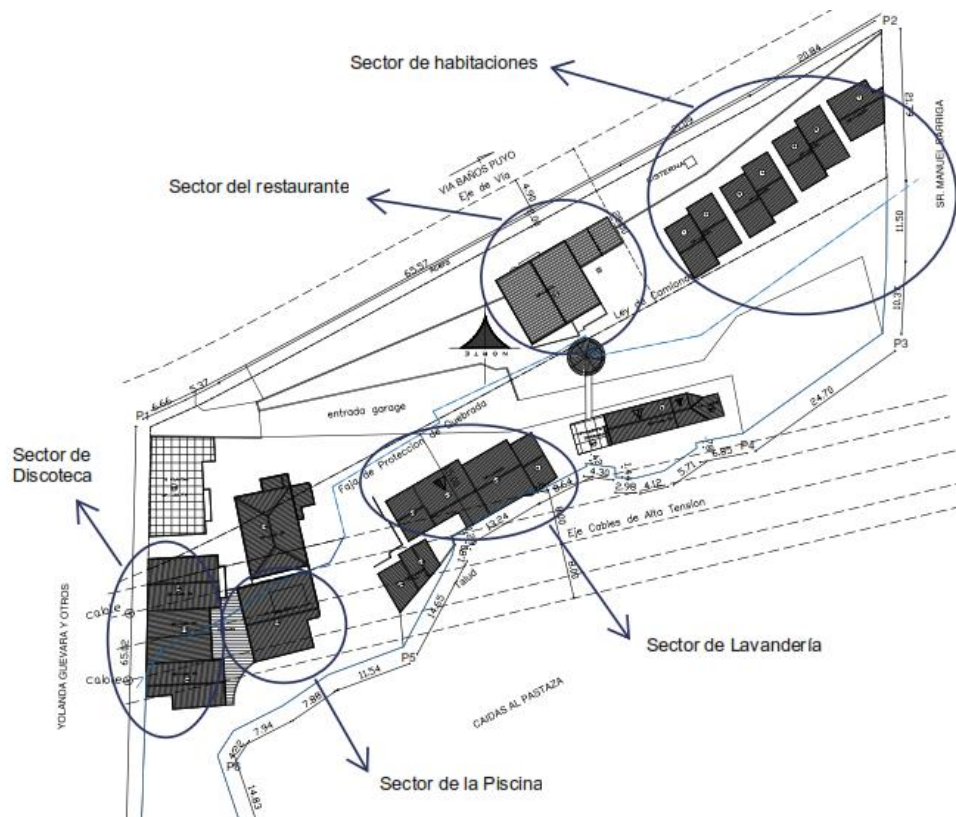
Planimetría de la Hostería Agoyán. [Hostería Agoyán]
